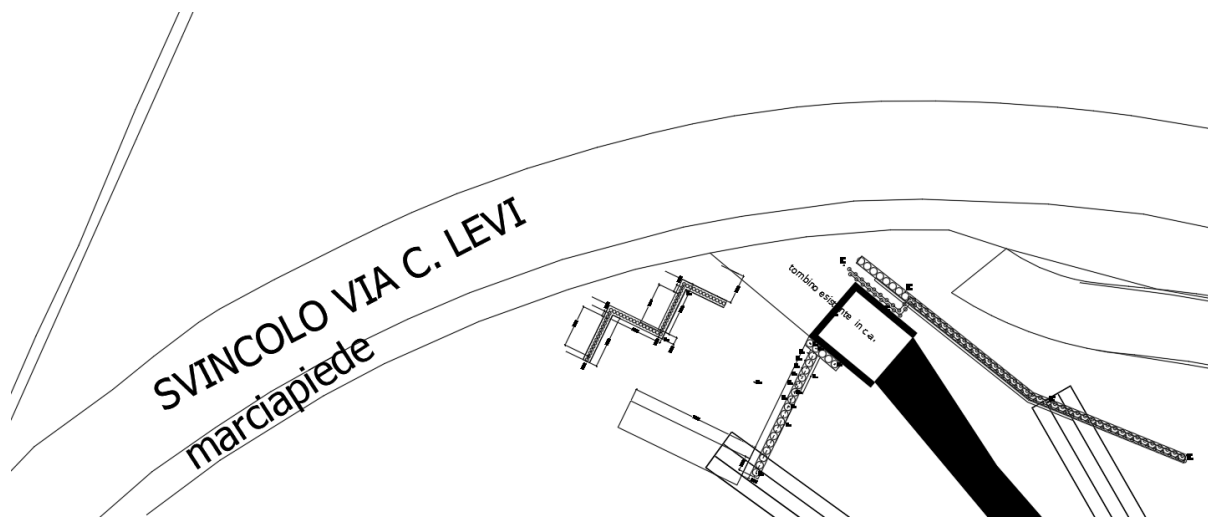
| Stralcio Planimetrico Generale – Struttura esistente.
